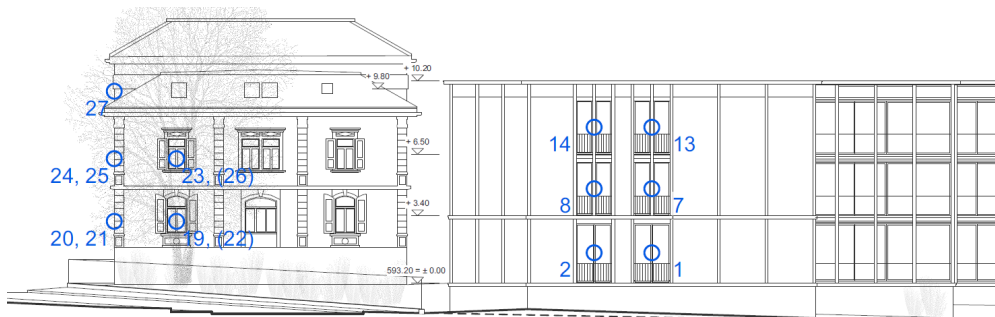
Ansicht Südwestfassade Altbau und Neubau mit Ermittlungspunkten
